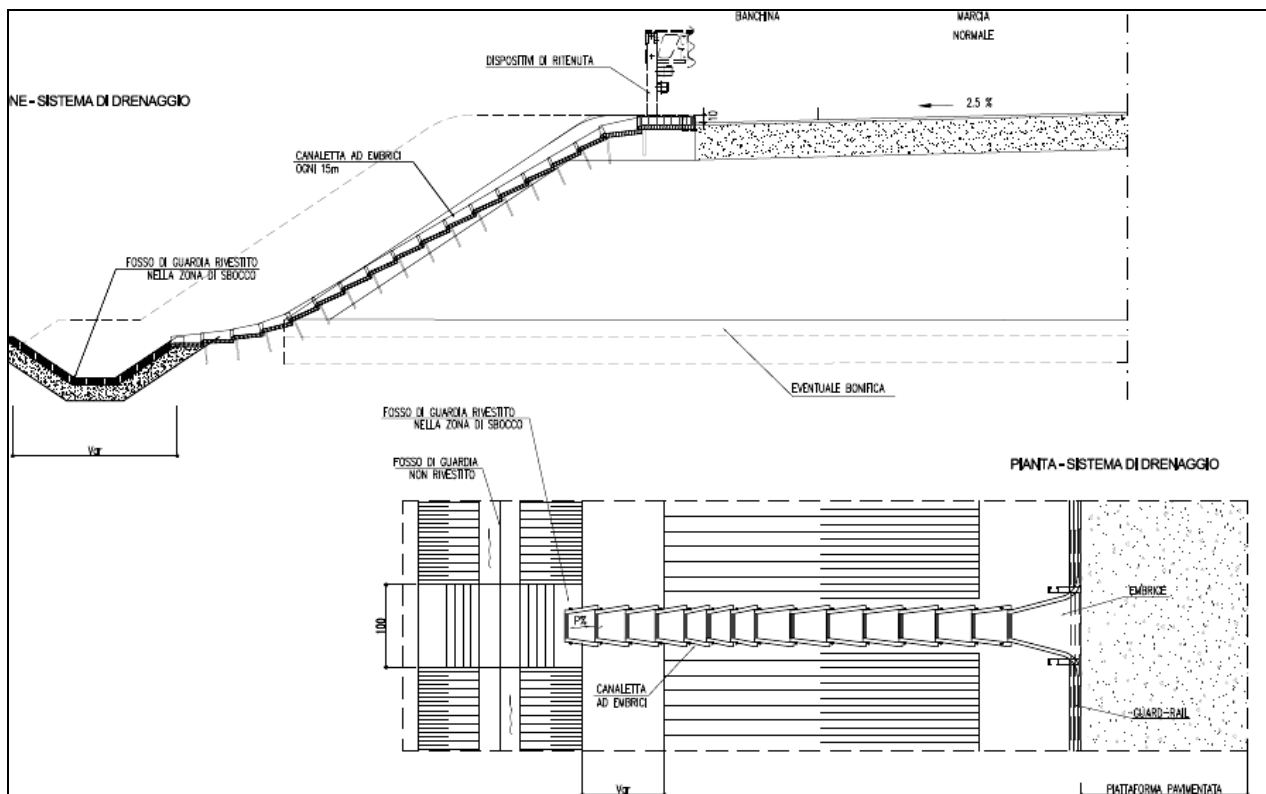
PARTICOLARE CANALETTE AD EMBRICE
